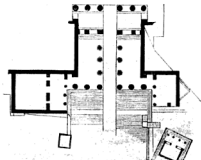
Grundriss der Propyläen zu Athen.
